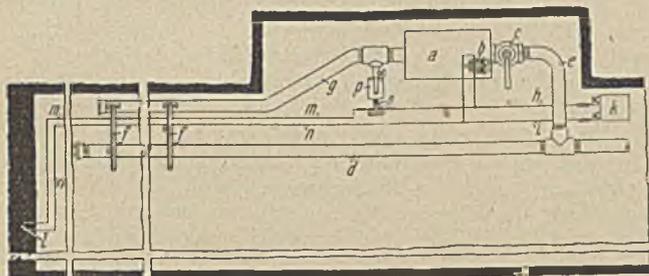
Schematische Anordnung des Explosionsverhüters.
